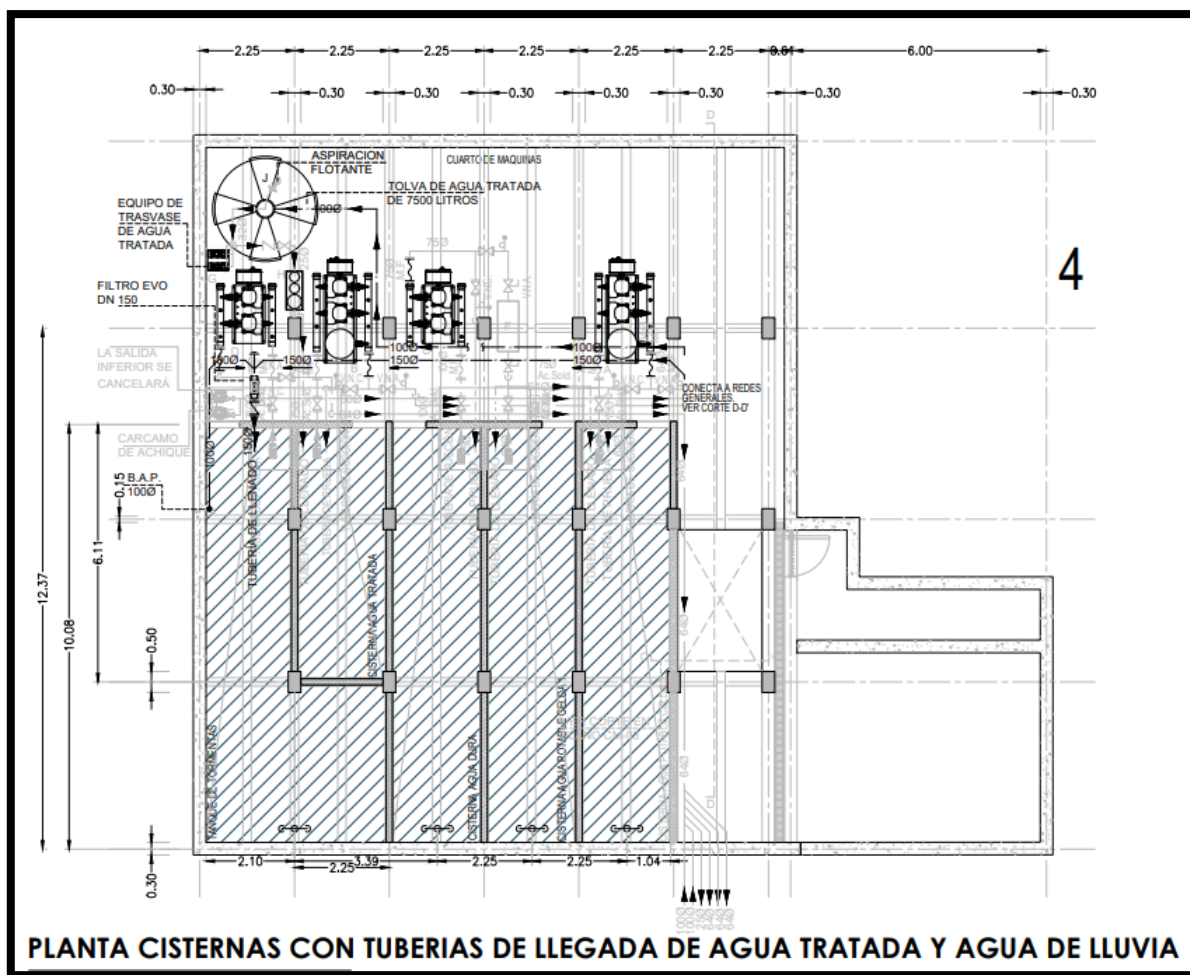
Plano de construcción del cuarto de máquinas y planta de tratamiento
